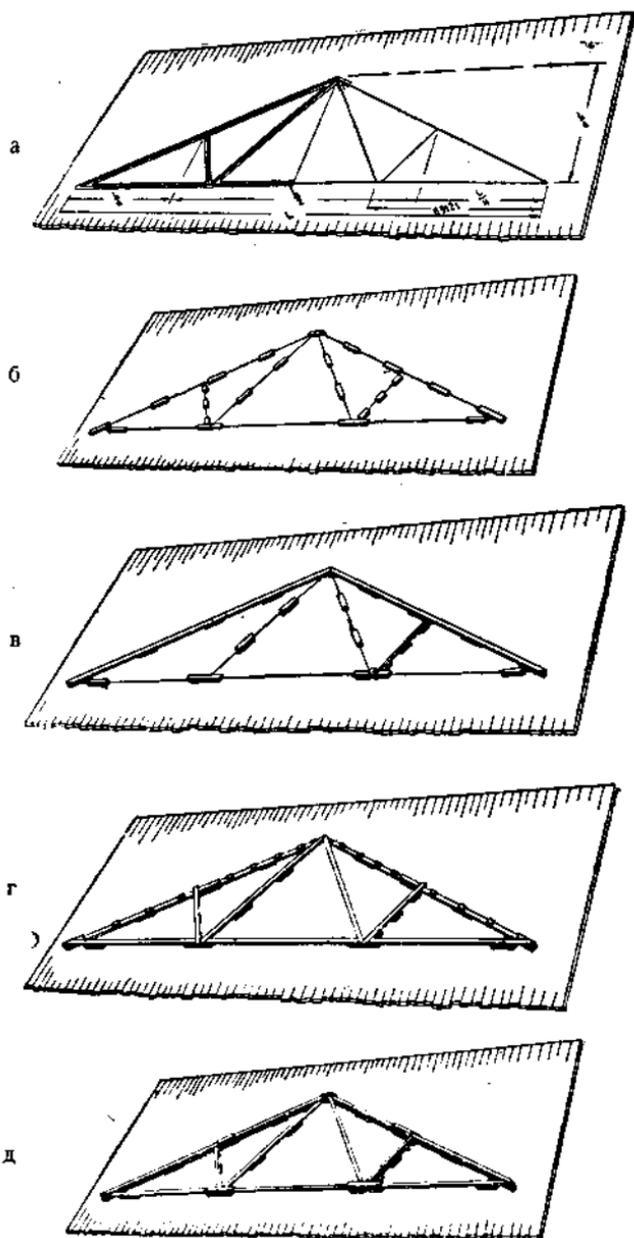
а, б, в, г, д. Сборка фермы на нагелях.
